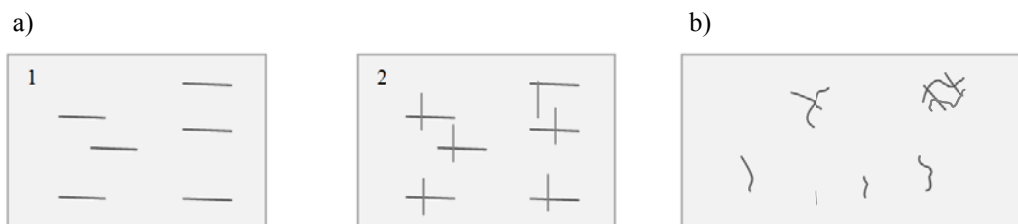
Esquema de fissura: a) evolució d'una fissura de retracció plàstica i b) esquema general incloent-t'hi un niu de fissura.
